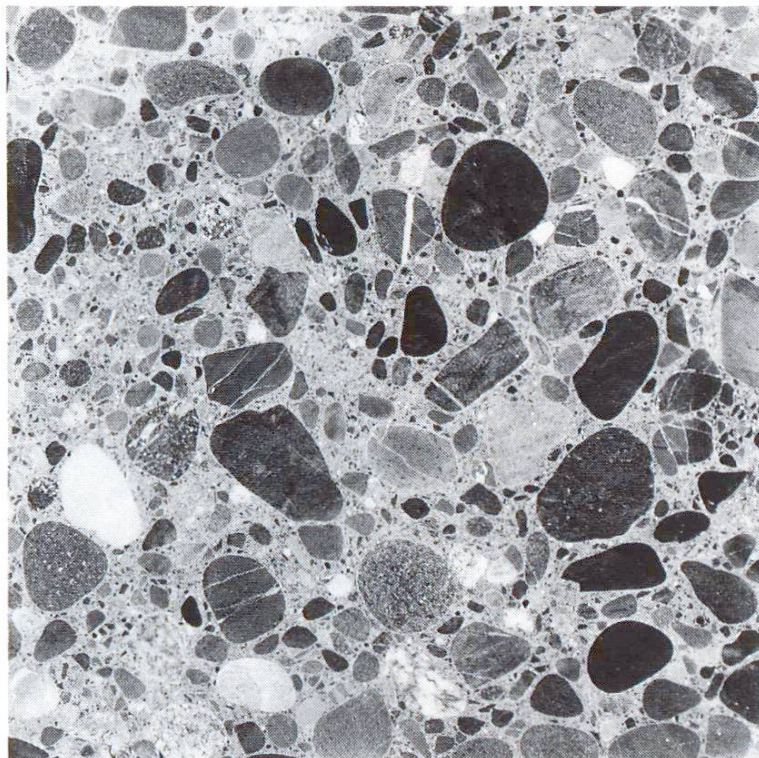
b Betonstruktur zur Siebkurve A (Sägeschnitt)
